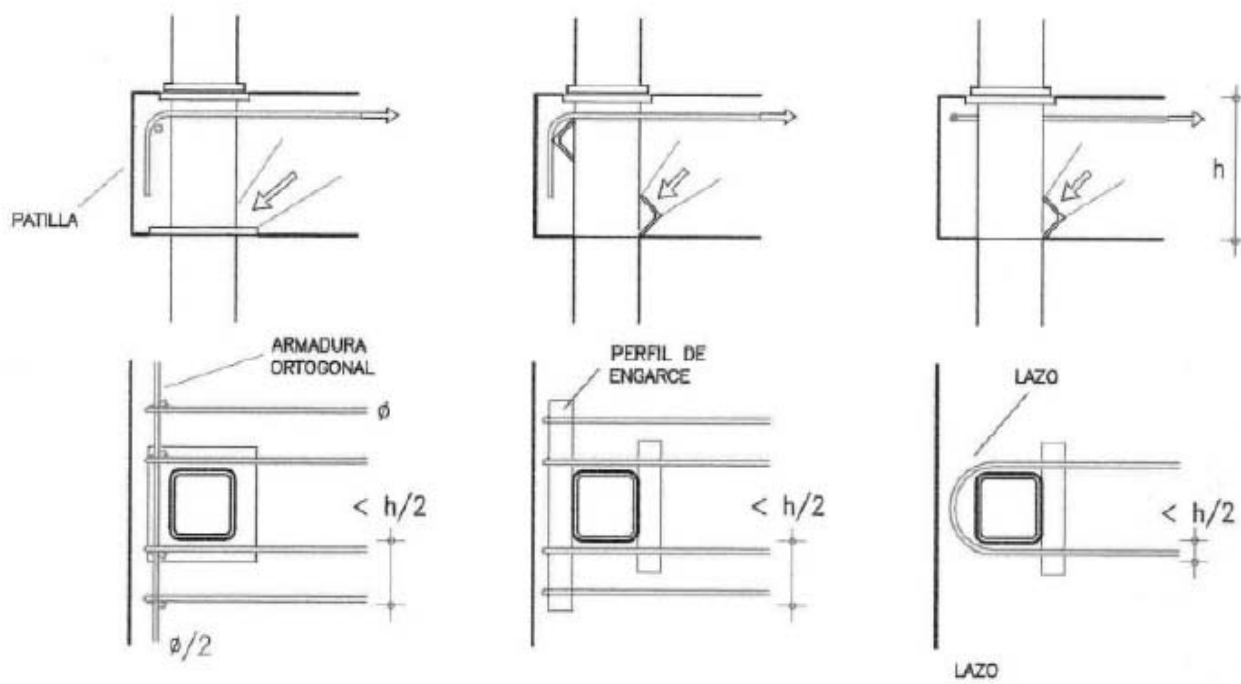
Armaduras superiores en nó extremo con soporte metálico.
